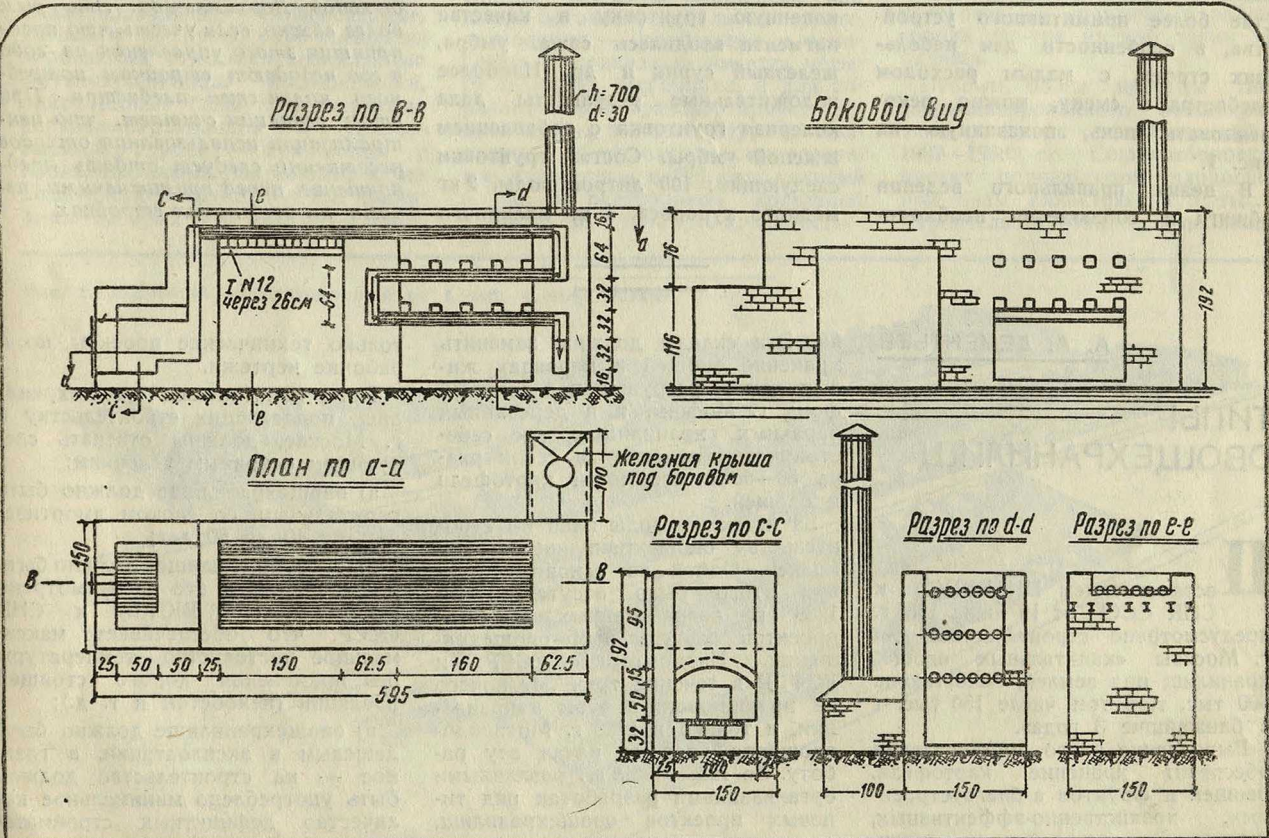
Комбинированная трубчатая печь для обжига гипсовых отходов с двумя рядами труб и камерой для сушки древесного топлива.
